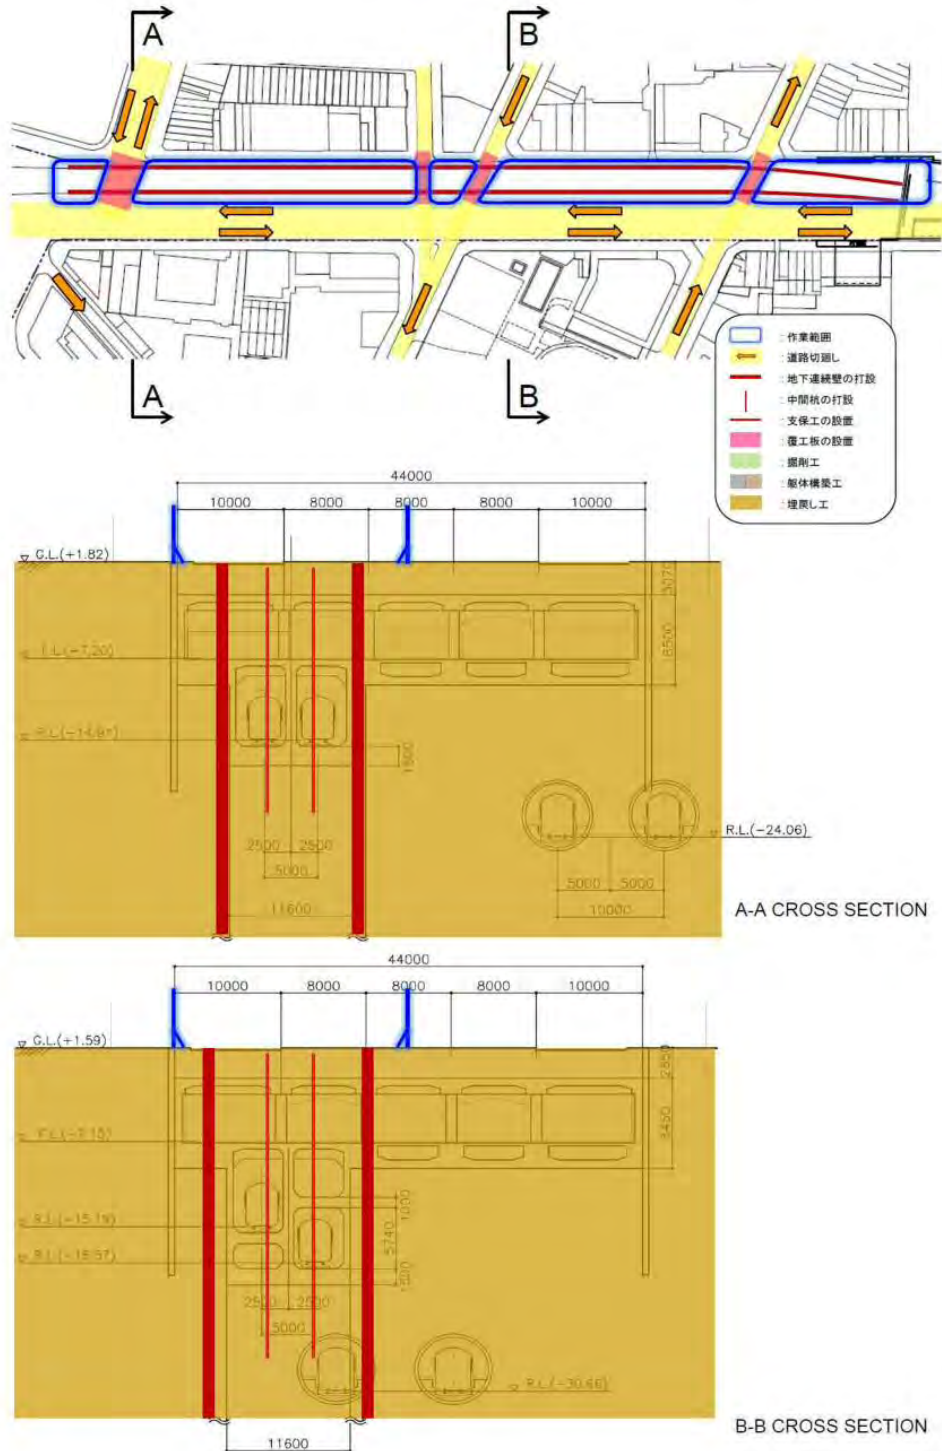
レロイ通り地区の都市鉄道1号線と地下街の施工手順図 (その3/14)
